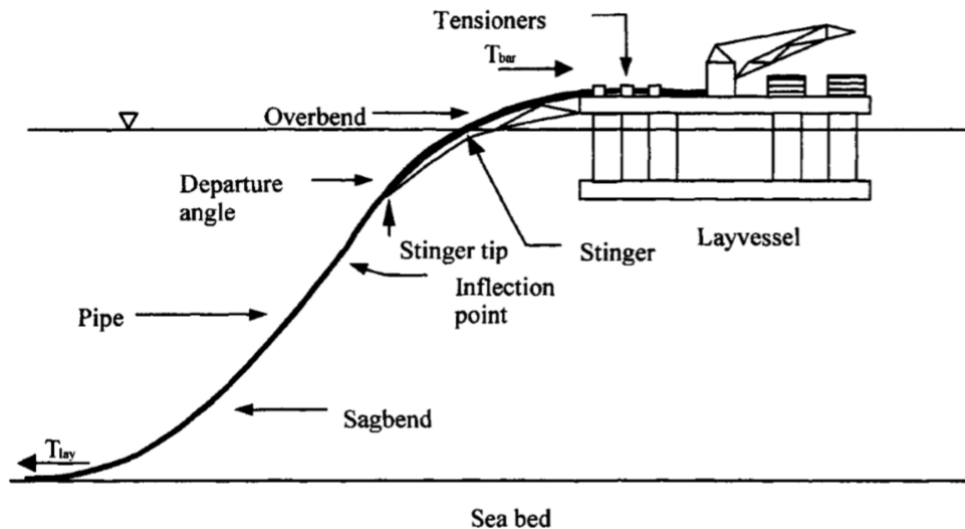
Pipe Laying Barge Tampak Samping- Profil View (Lee, 2009)
